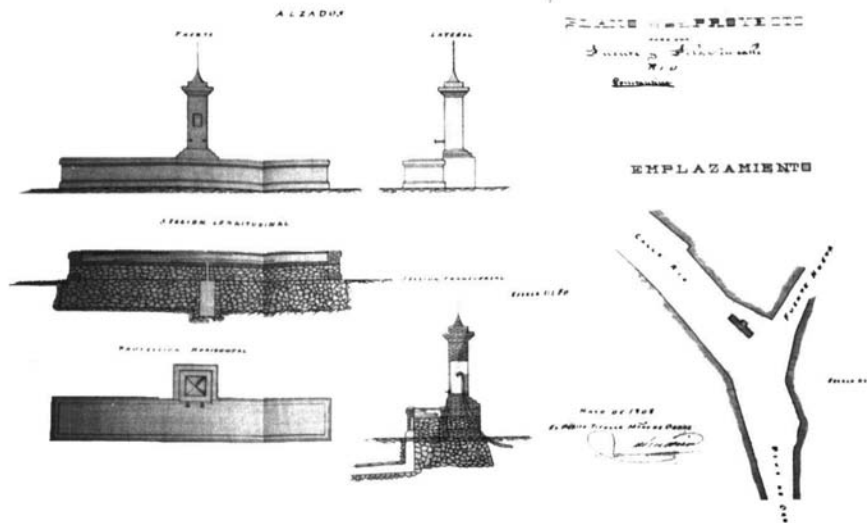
Plano del proyecto para una fuente y pilar en calle Río, Constantina, Mayo de 1908, A.H.M.C. Obras públicas. Leg. 1091.
